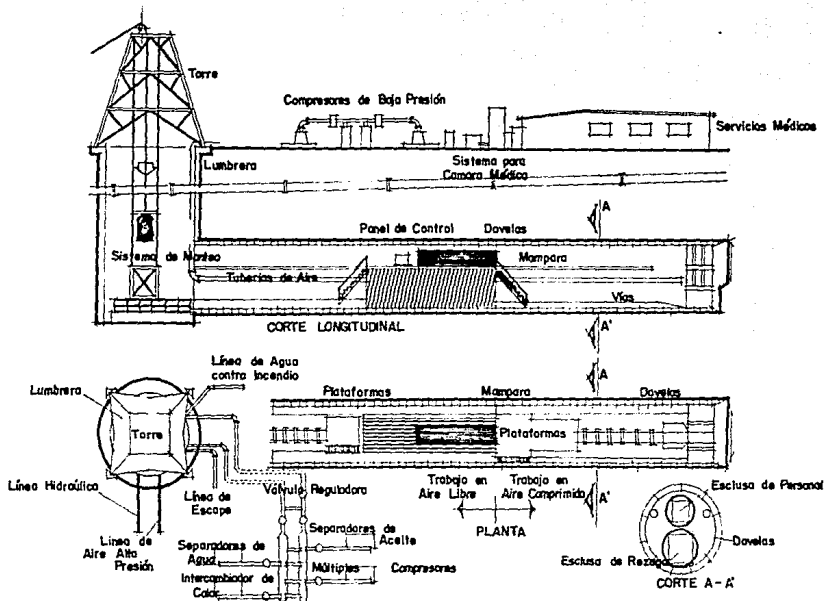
ELEMENTOS REQUERIDOS PARA EL TUNEL CON AIRE COMPRIMIDO
